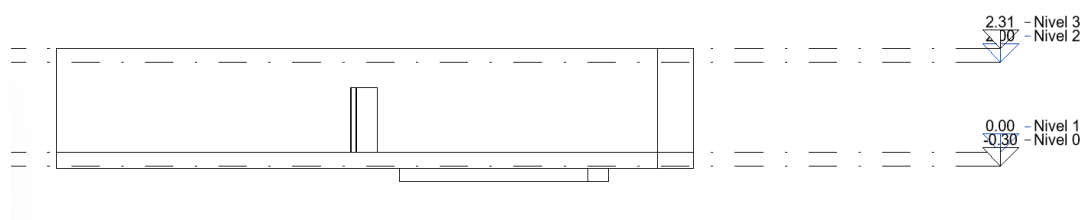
Alzado Este modelo levantamiento con Cámara 360°. Fuente: elaboración propia.
